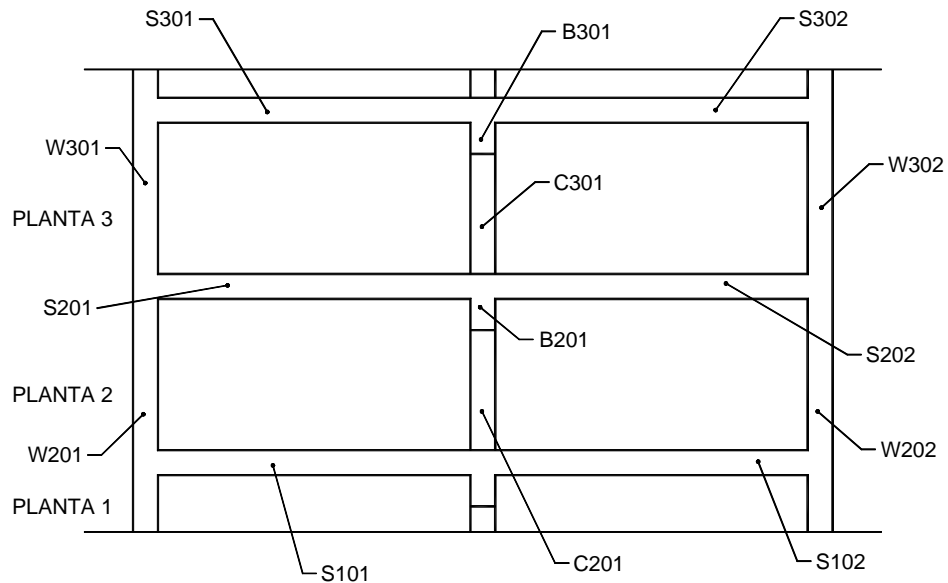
Ejemplo de designación de columnas, placas, paredes y vigas de la segunda planta
